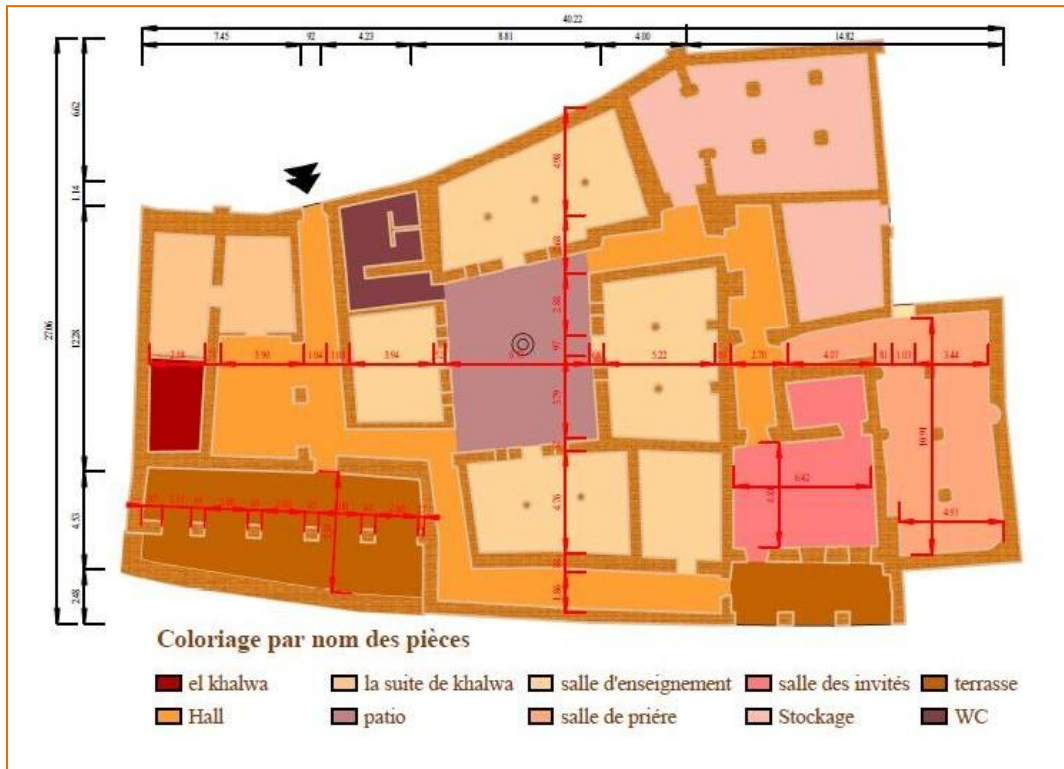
Plan de la Zaouia du ksar de Boussemhoun (Ait SAADI)
